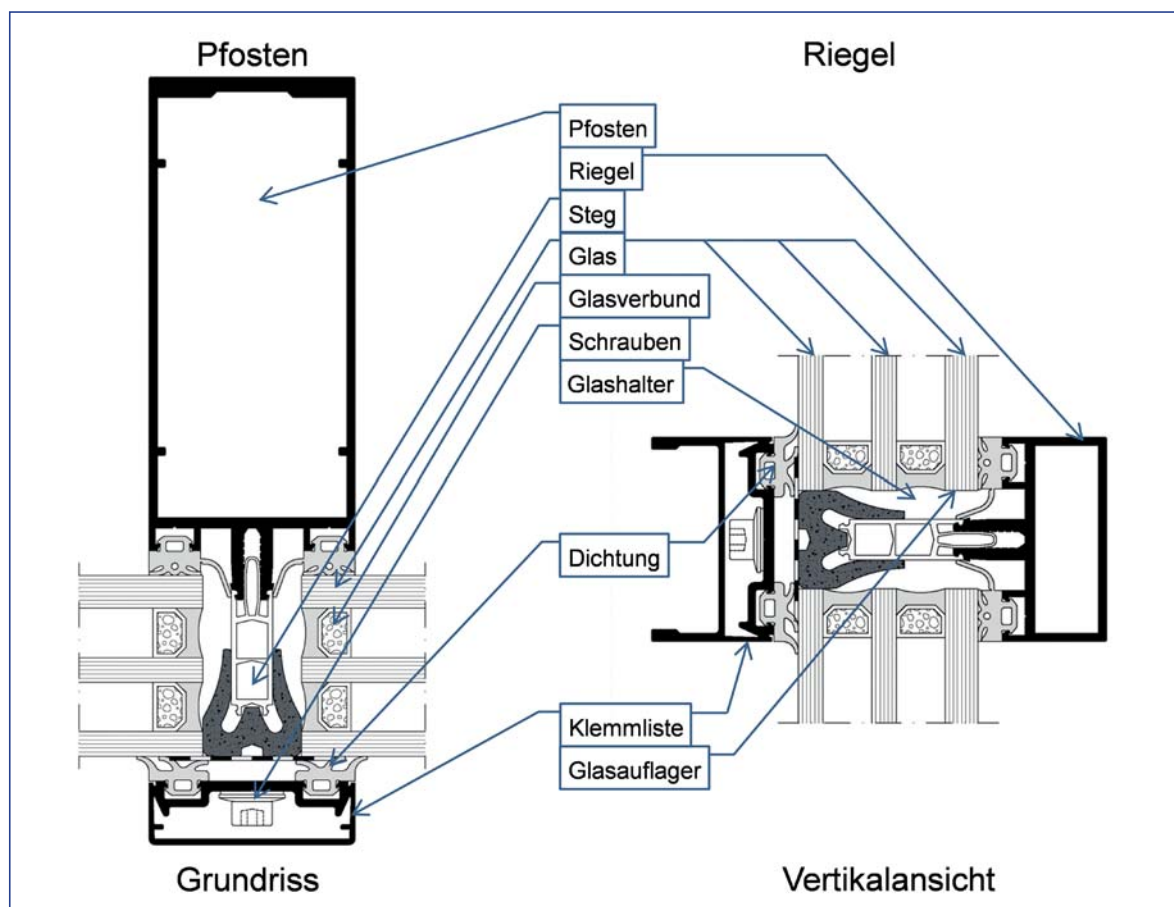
Pfosten-Riegelkonstruktion mit Grundriss und Schnitt
